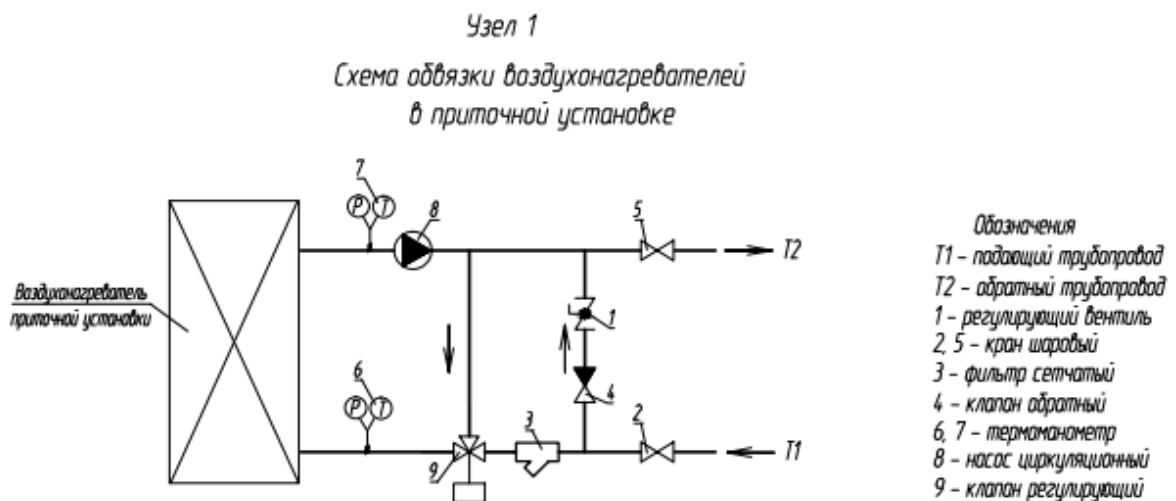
Схема обвязки воздухонагревателей в приточной установке
